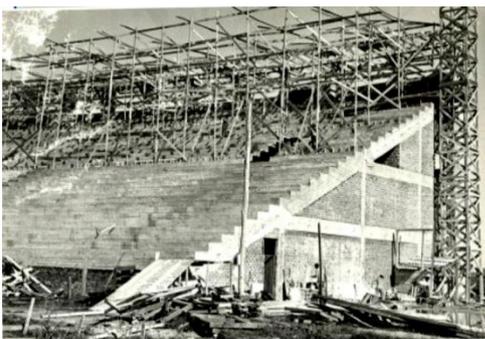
Início da construção do Estádio, com a edificação dos quatro blocos de arquibancada, e as fundações de outros blocos que acabaram nunca sendo edificados (FONTE: Acervo da UFSM, 2009)
